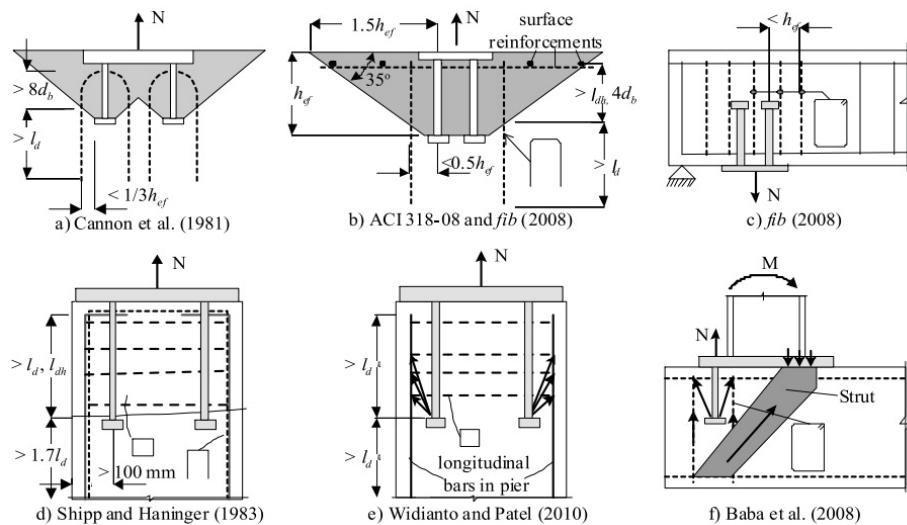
Esquema de refuerzo existente de pernos de anclaje a tracción. Fuente: *Design of anchor reinforcement for seismic tension load*, Węglorz, M. (2017).
